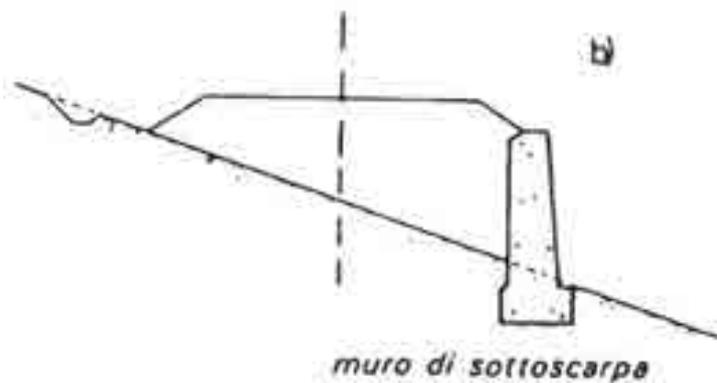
Costruzione di muro di sostegno per sezione stradale in rilevato
